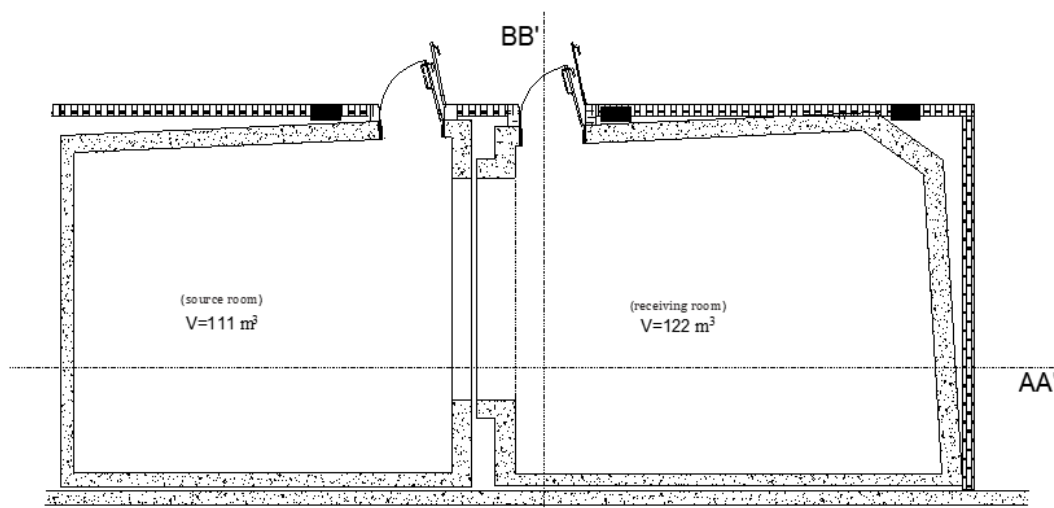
Vista em planta das câmaras reverberantes do DEC-UC
